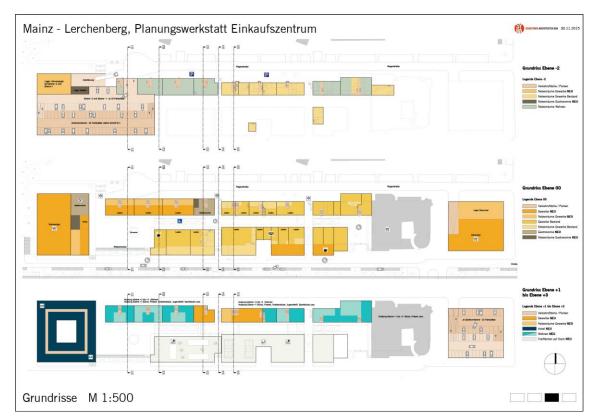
Exemplarische Grundrisse, Vorentwurf Schoyerer Architekten
